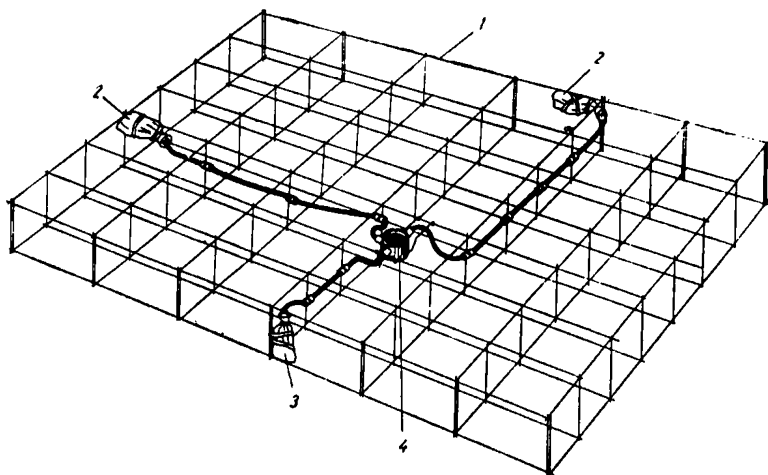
Закрепление электропроводки на объемном металлическом арматурном каркасе железобетонной прокатной панели
